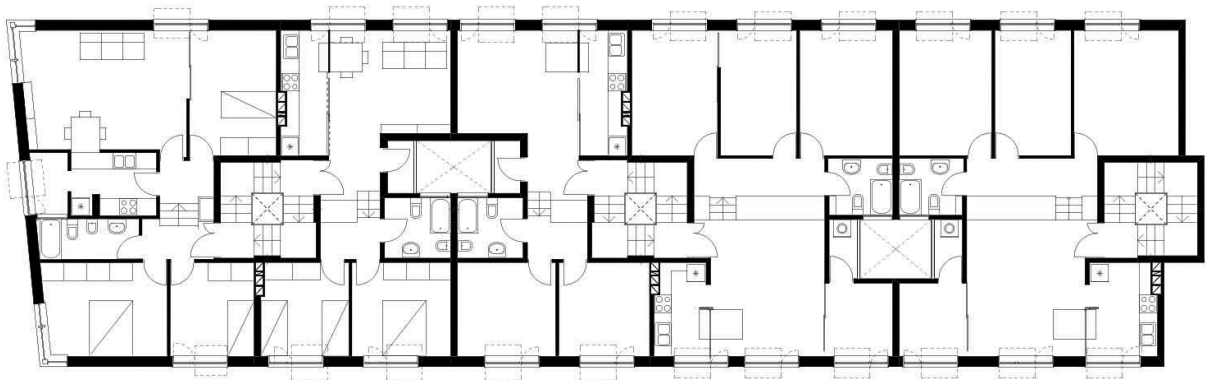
Planta tercera de la calle Sang formada por viviendas tipo A y E.
